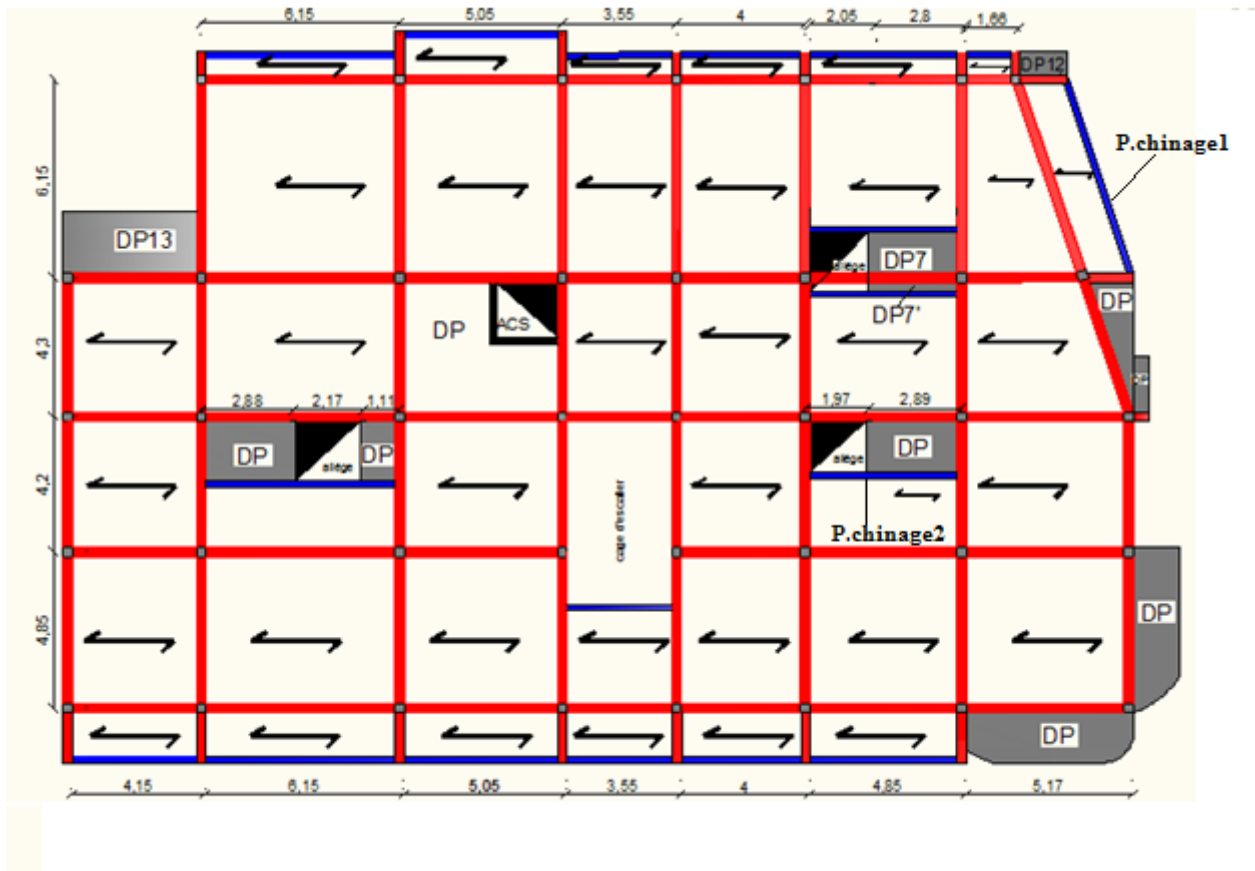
Disposition des poutrelles (1^{er} étage).
